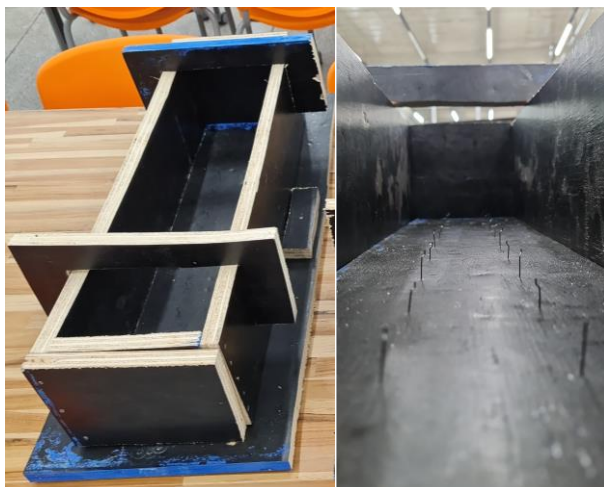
Fôrma de madeira e fibras posicionadas na tábua de fundo. Fonte: Autor.
